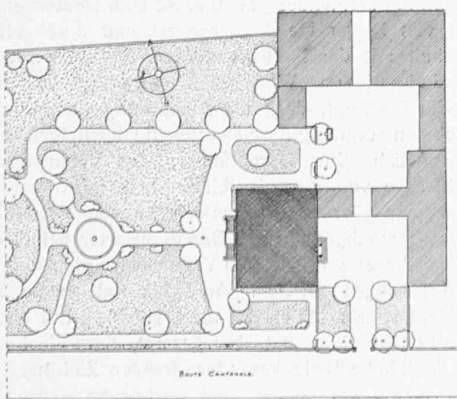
Grand Clos in Rennez. — Lageplan 1:1500.
